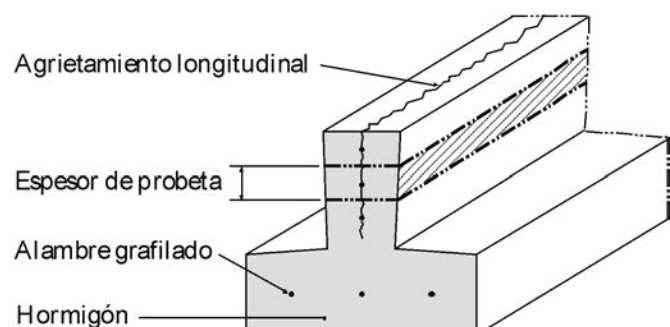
Vigueta de hormigón pretensado longitudinalmente. Se indica la fracción de vigueta que fue reproducida en los ensayos.
